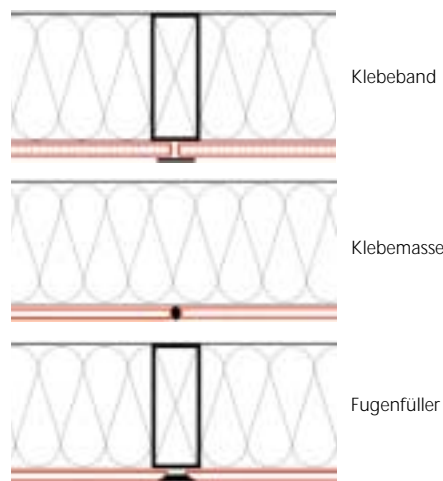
Prinzipskizze für die Ausbildung von Stößen mit einseitigem Klebeband, Klebemasse und Fugenfüller [13].
